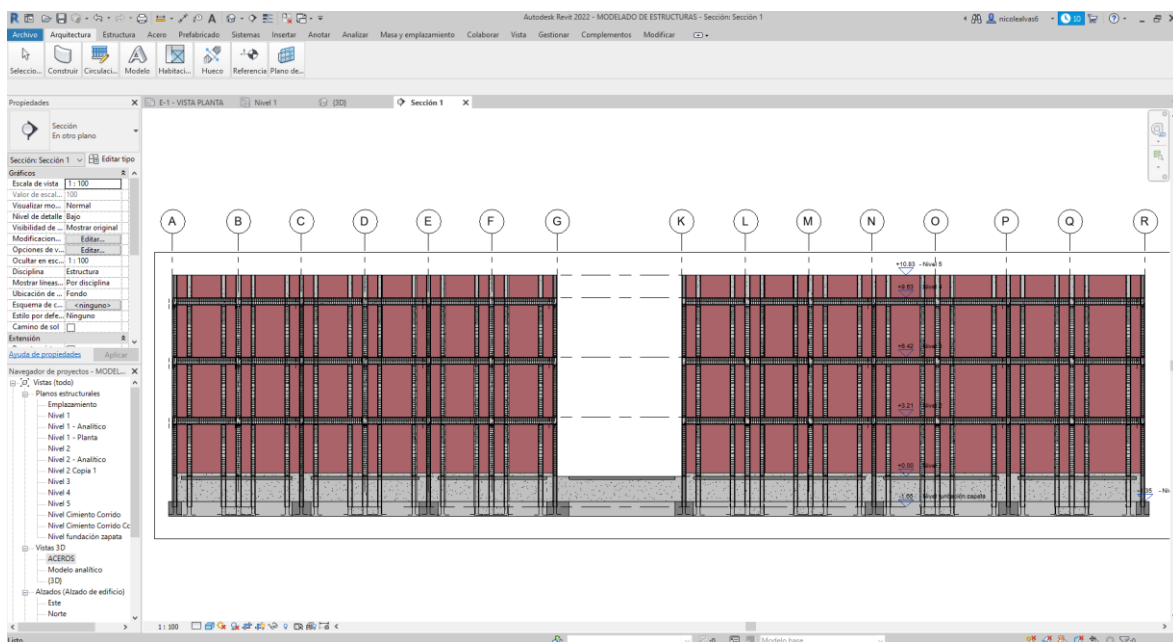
Corte para observar el refuerzo estructural de vigas y columnas
